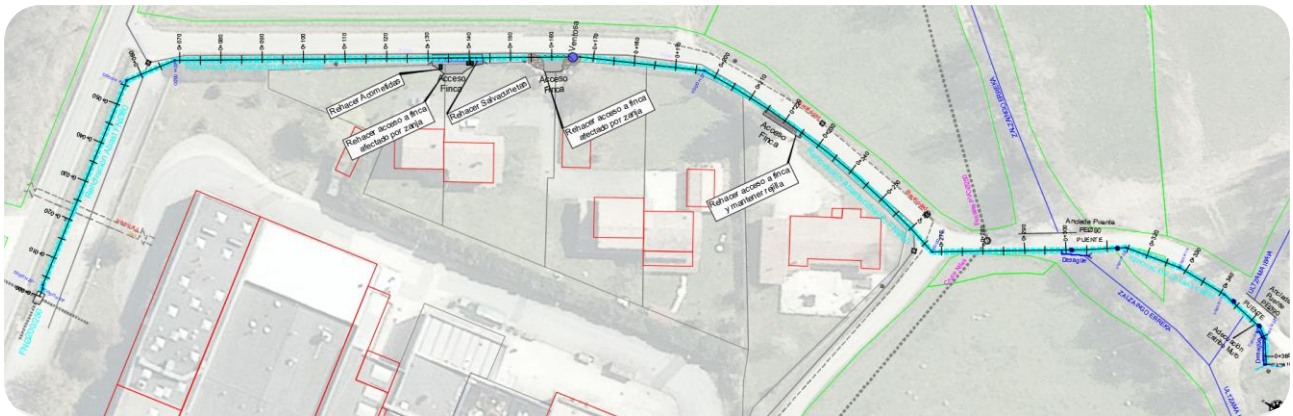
Planta diseñada para la renovación del Ramal de Lozen
